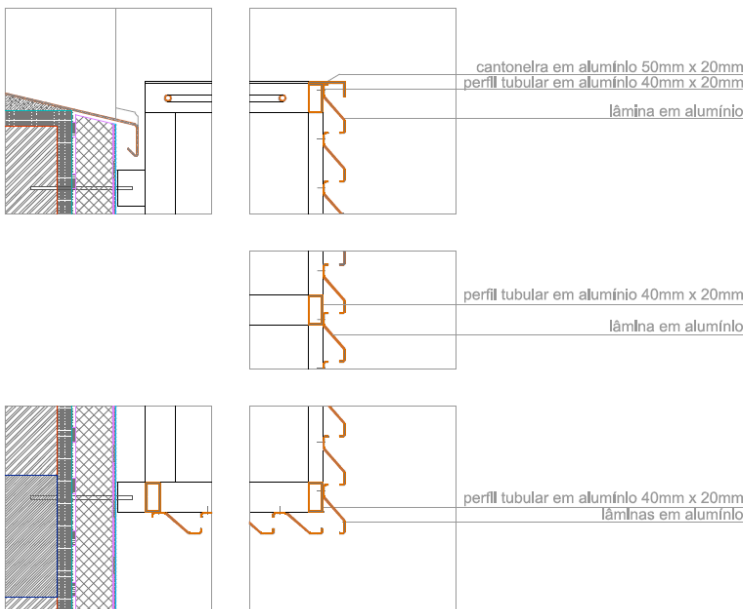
Estendal. Pormenor construtivo vertical (escala 1/10).
